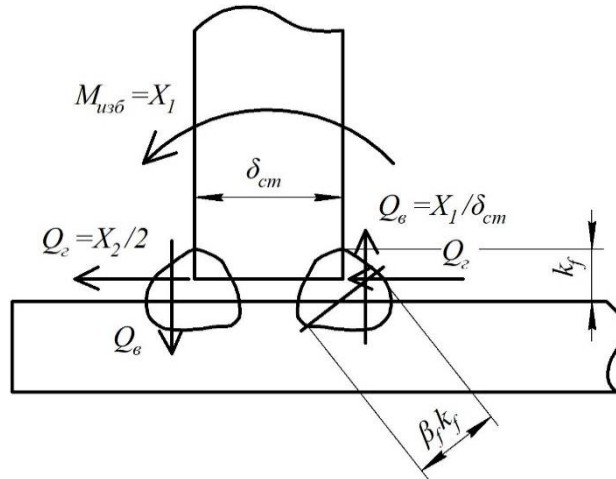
Узел сопряжения стенки резервуара с дном с двумя угловыми сварными швами
